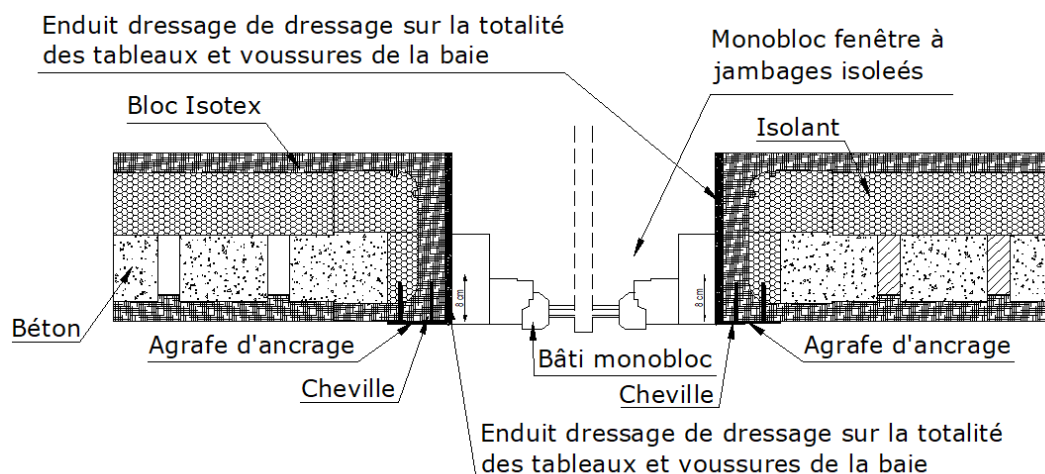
exemple de pose directe sur blocs bois ciment avec enduit de dressage des tableaux
